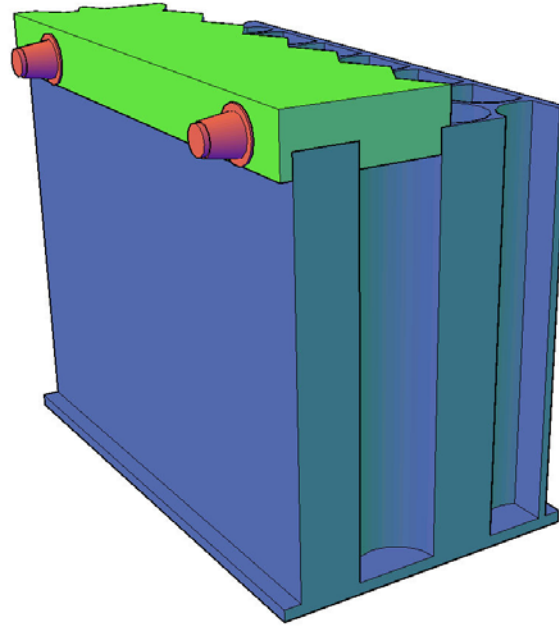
Viga cantil integrada en el cajón. Muelle del Prat, Fase II, Puerto de Barcelona, 2009
